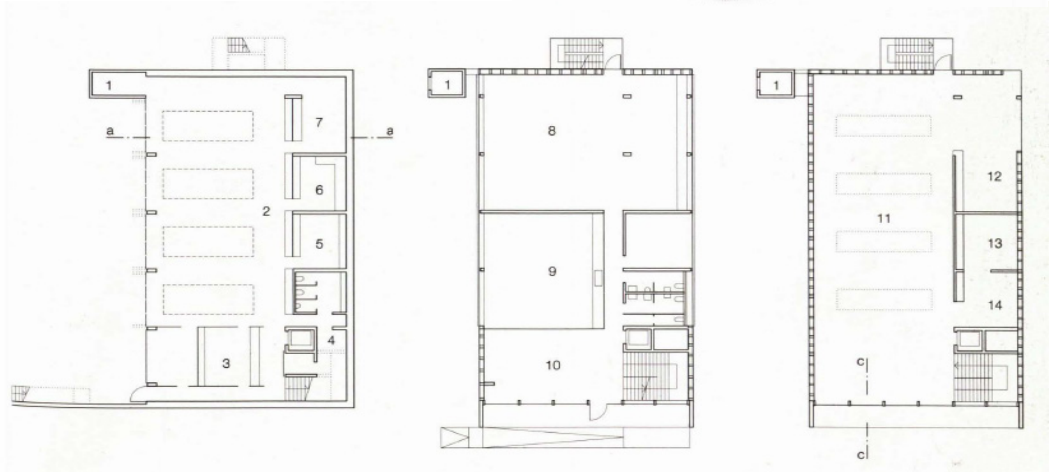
Kultur- Feuerwehrhaus in Hittisau, Lageplan und Grundrisse
